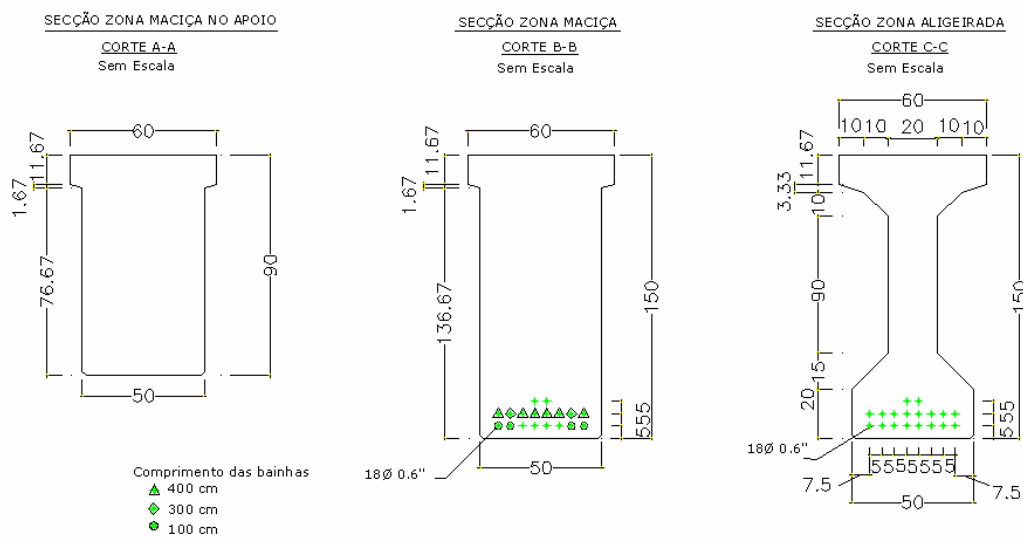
Secções transversais da viga pré-fabricada (dimensões em cm)
